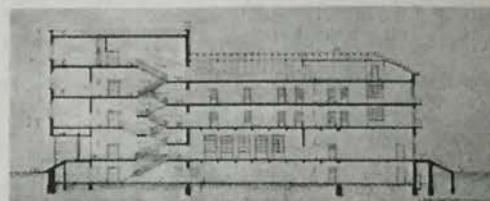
b - Convitto Biellese - I progetto: sezione longitudinale.
